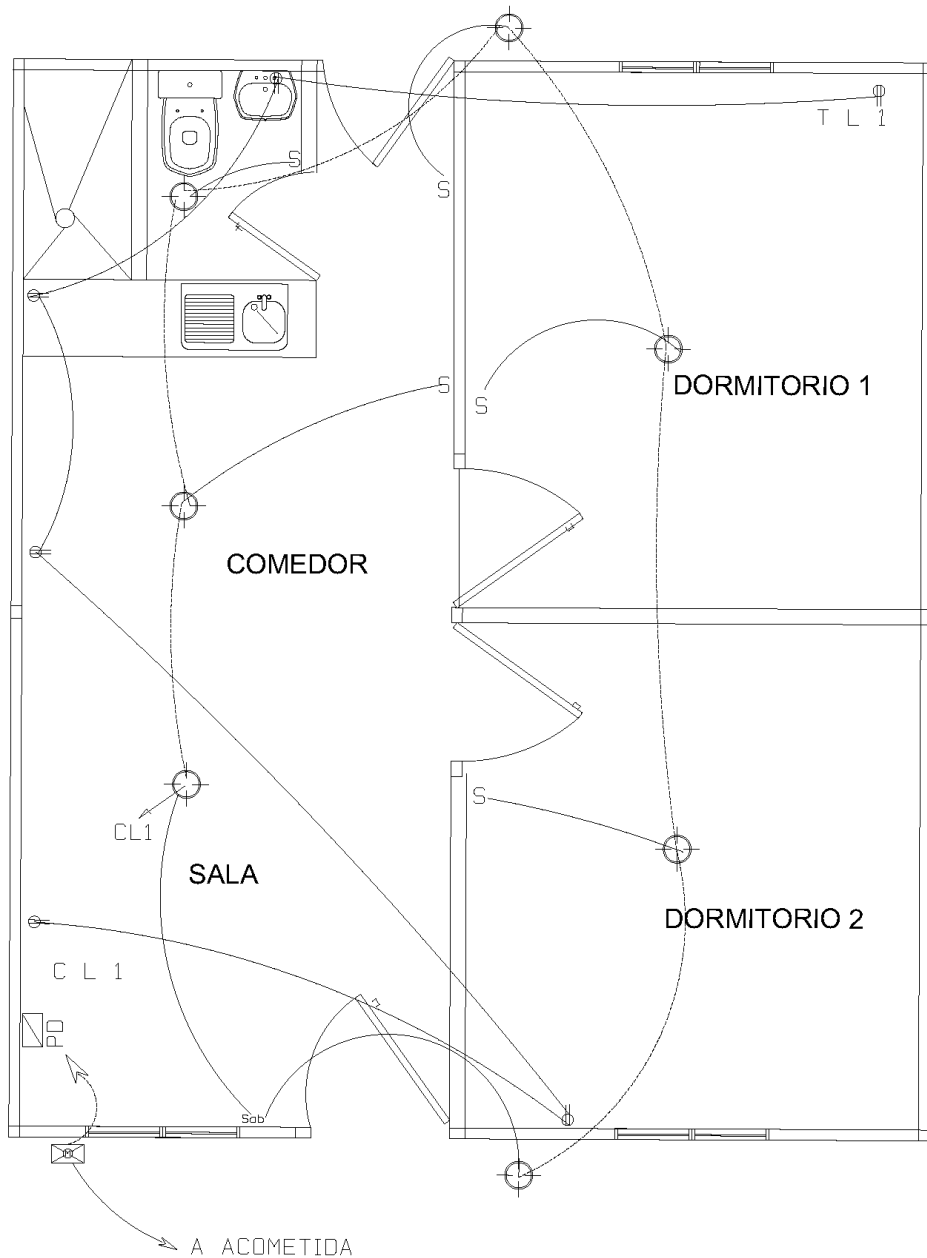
Plano de instalaciones eléctricas de la vivienda de bambú.
